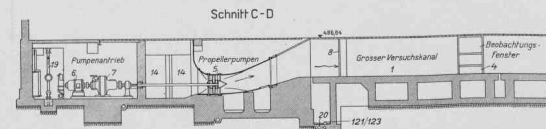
Längsschnitt C-D durch das Kellergeschoss (vergl. Grundriss auf Tafel 13).
